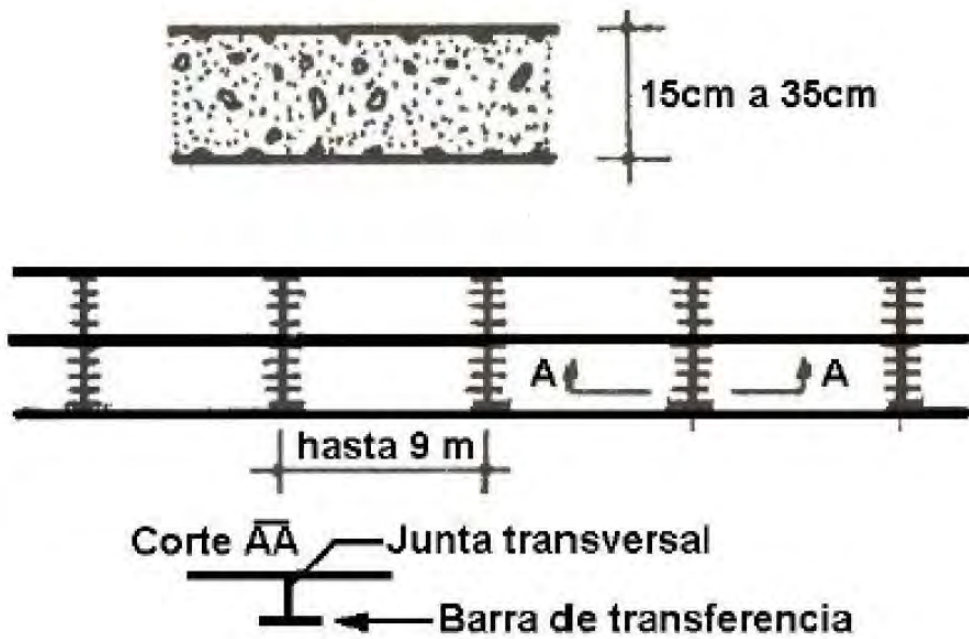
Pavimento de concreto simple con pasadores. Fuente ASOCEM (2016)
